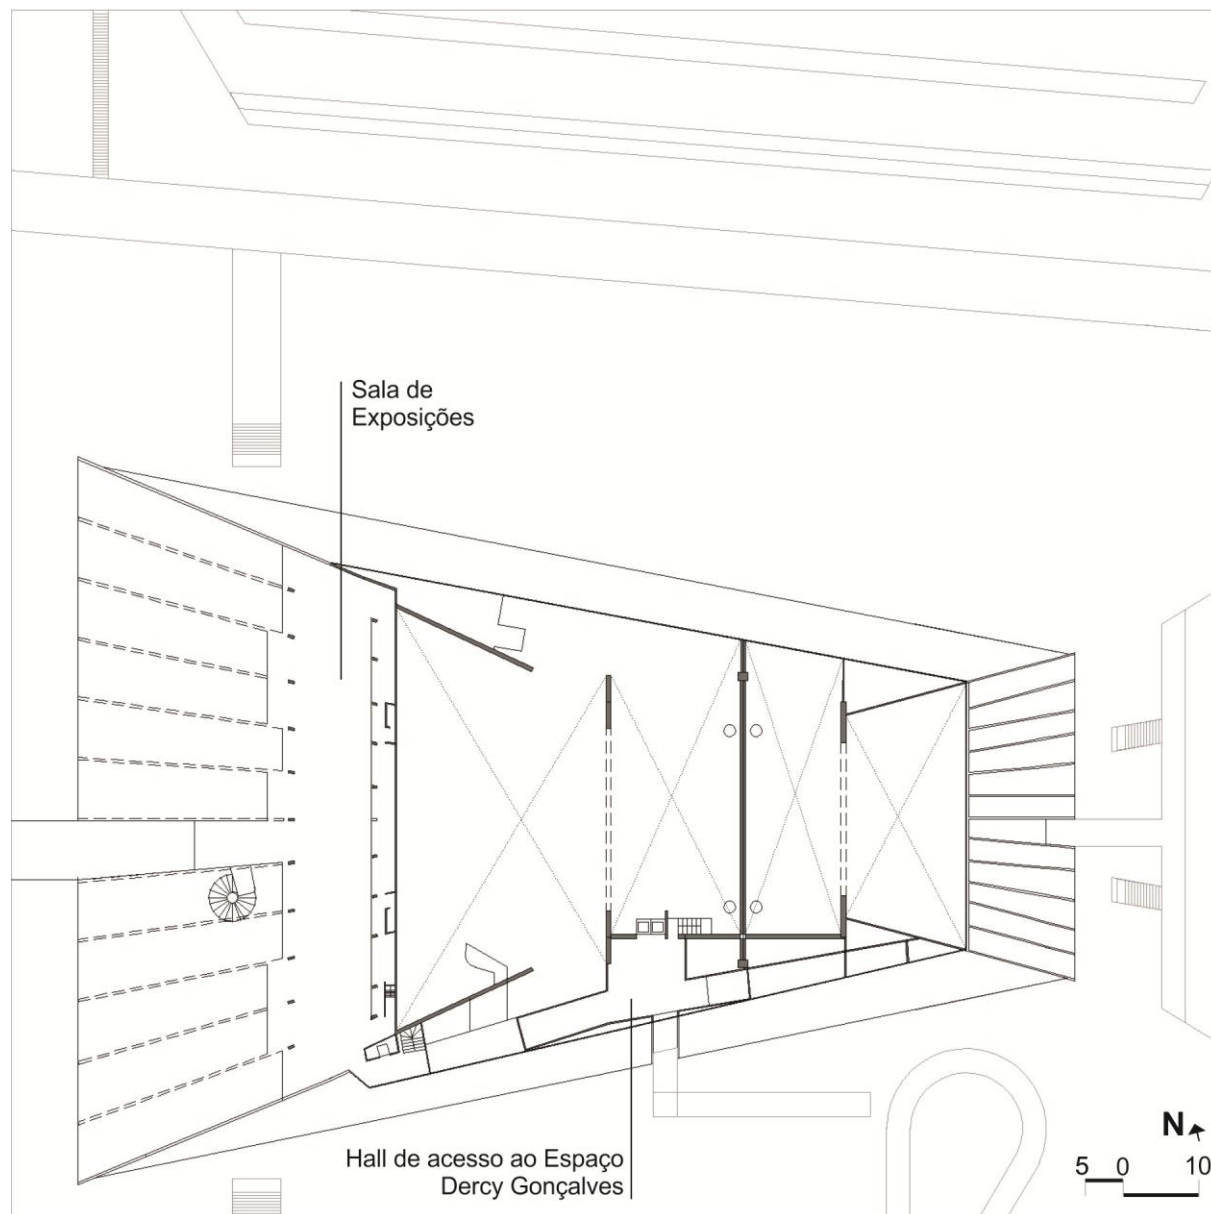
Planta Baixa - 1º Pavimento (+3,33 m).
